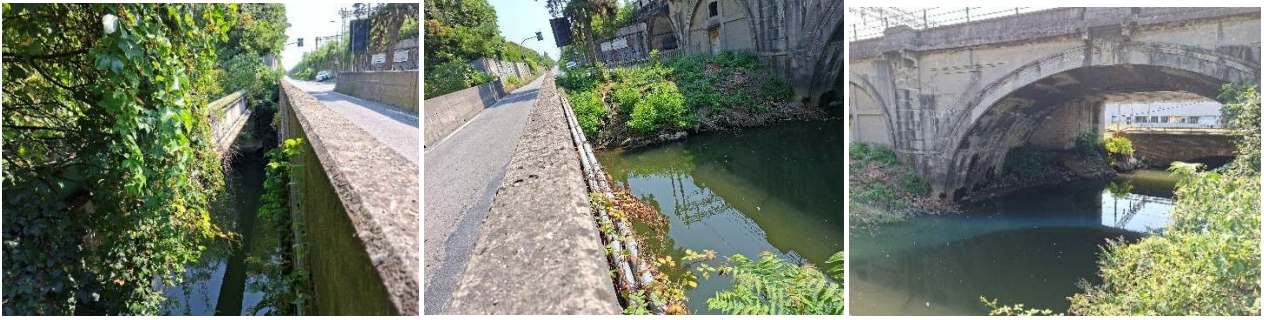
vista dal ponte di via Cima che diviene via Lazio in Milano – a sx il ponte canale sottoservizi, in centro il ponte di via Cima, la sponda sx e il rilevato ferroviario, a dx il ponte del rilevato ferroviario e il ponte FFSS
